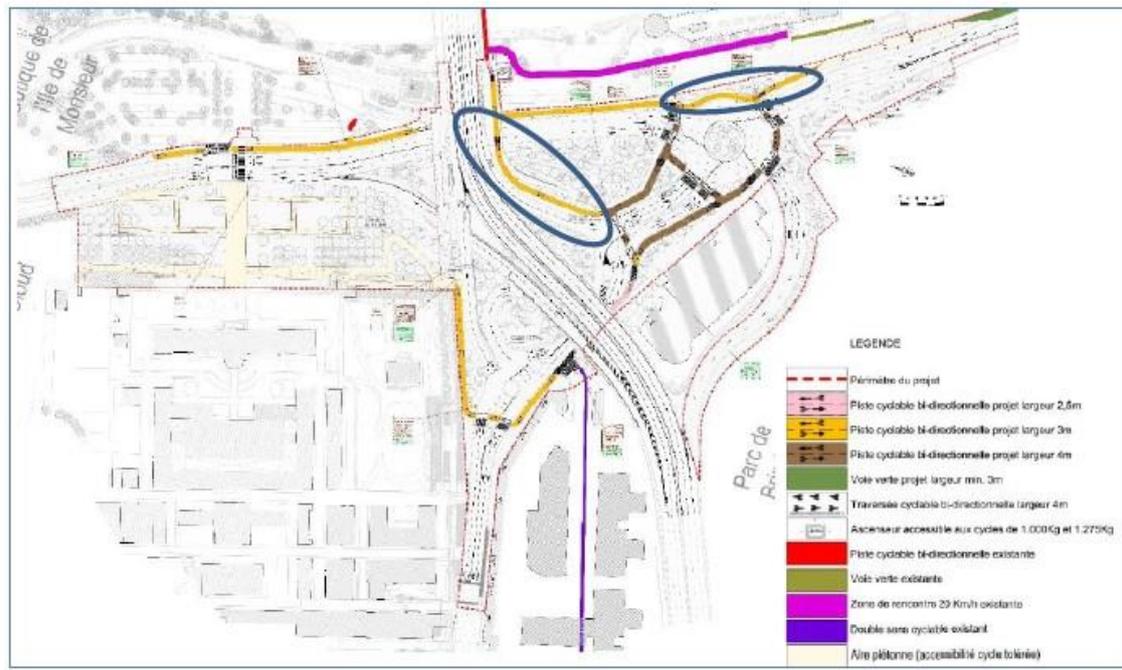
Plan des largeurs cyclables - En bleu les zones à réétudier (Pont de Sèvres / RD7)
